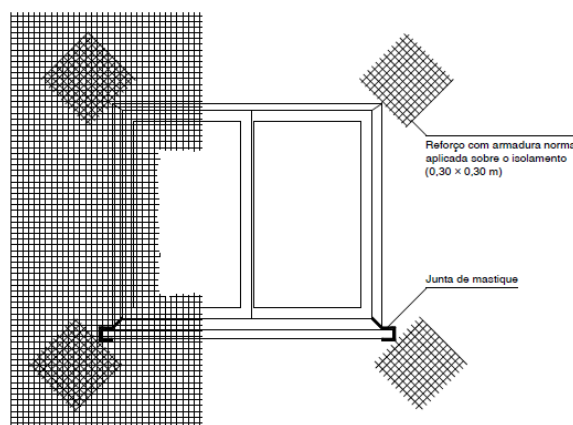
Reforço de armadura em arestas de janelas [18]
